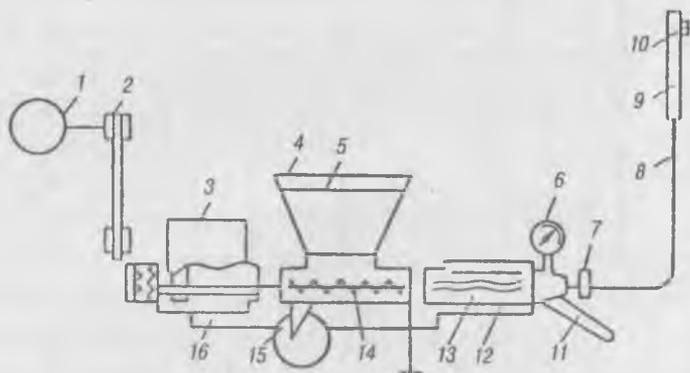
Схема устройства винтовых шпатлевочных агрегатов:
